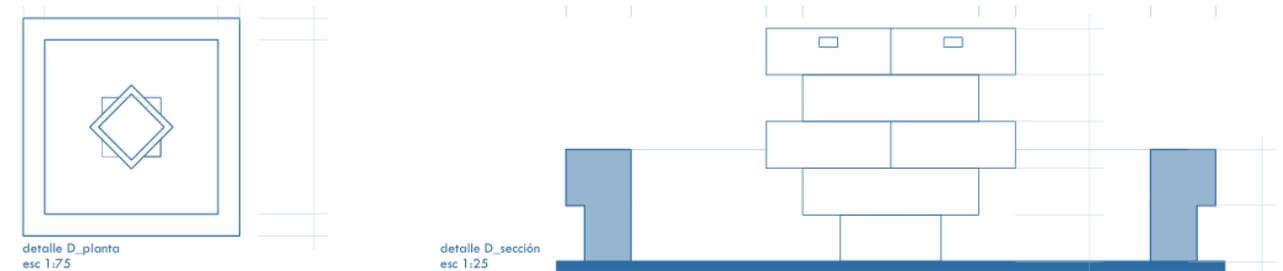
| Detalle de pileta patio central. Elaboración propia, 2021.
